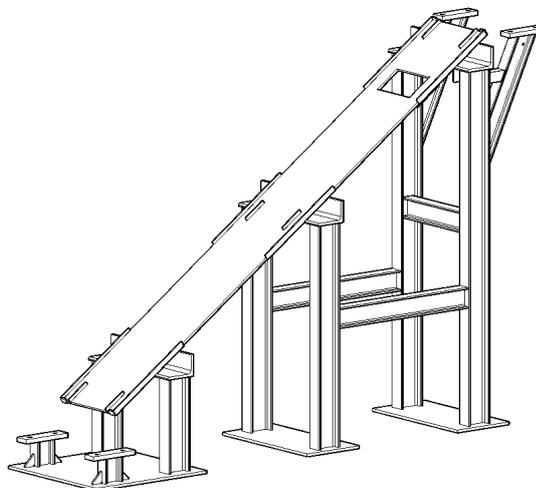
Estructura del elevador. Fuente: elaboración propia.
